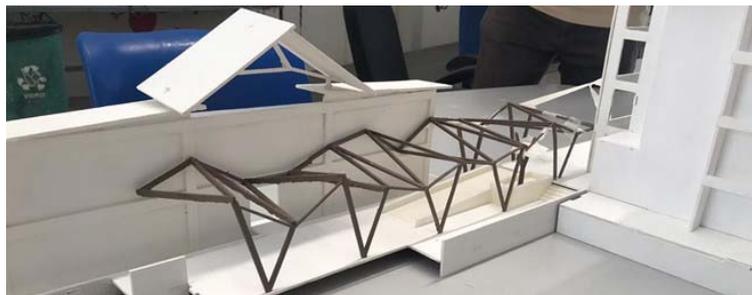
Seção do terreno, mostrando posição de fixação de vigas na fachada do galinheiro e pilares no solo.
